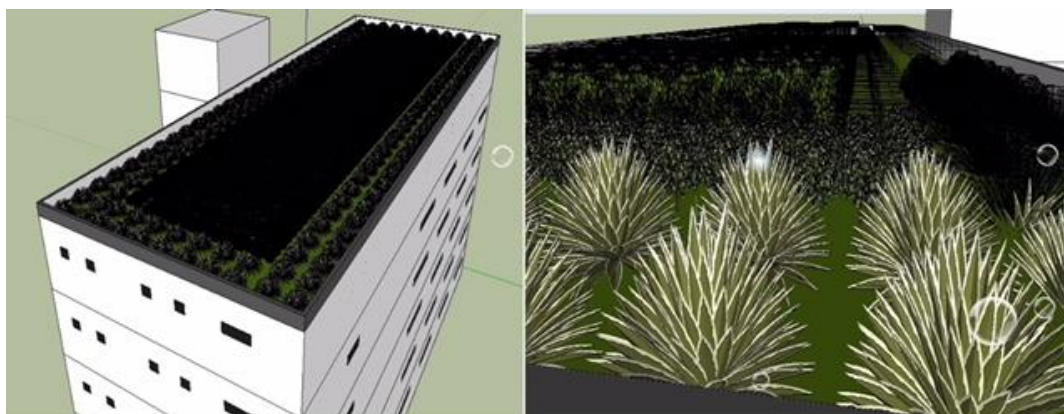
Proposta Telhado Extensivo Modular em 3D
